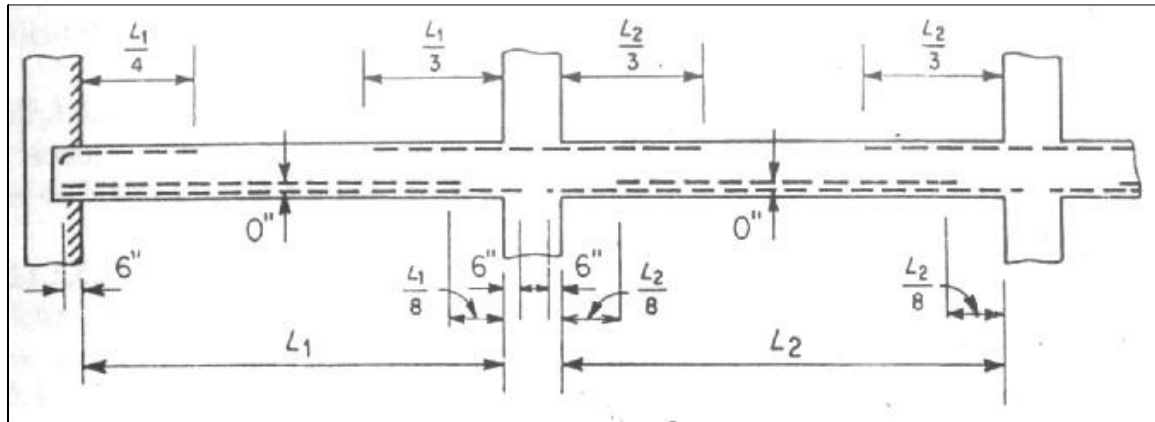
Largo Mínimo de Armaduras en Losas con Vigas.
